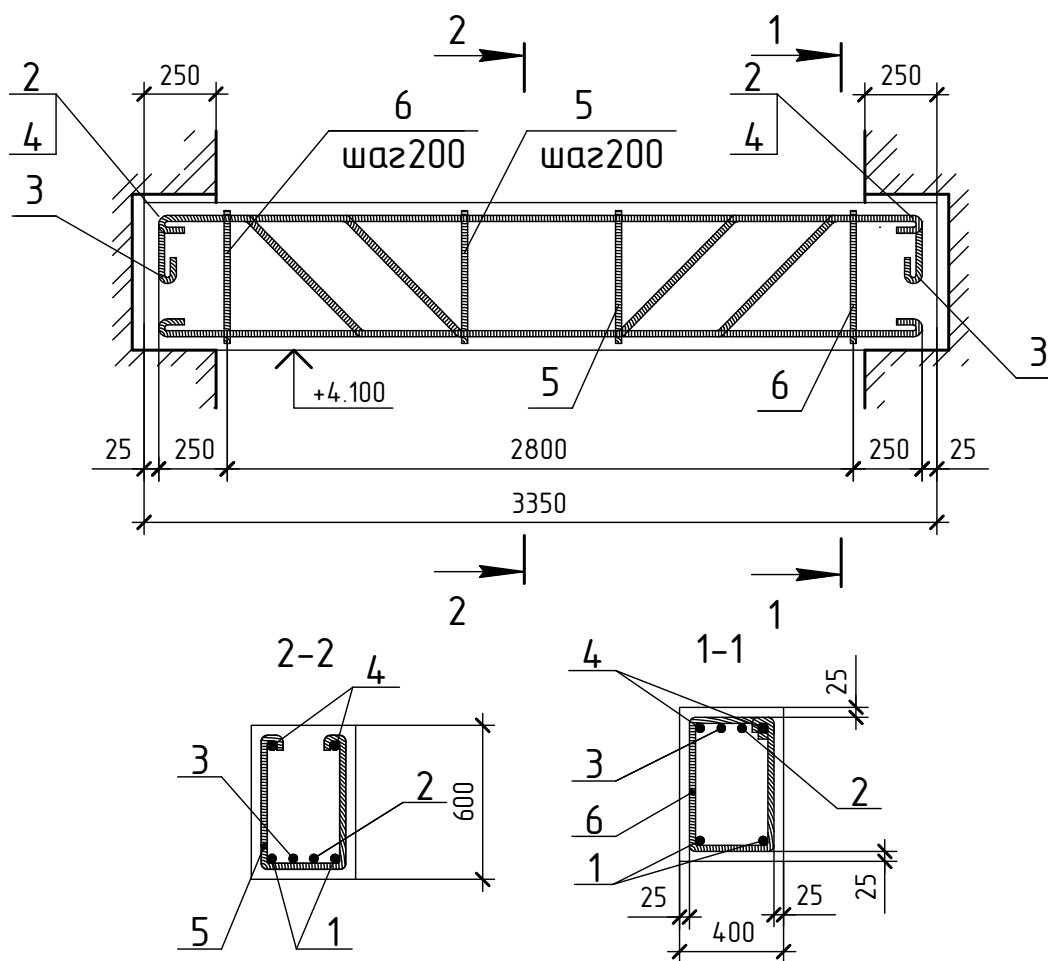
Сборочный чертеж монолитной балки БМ1
